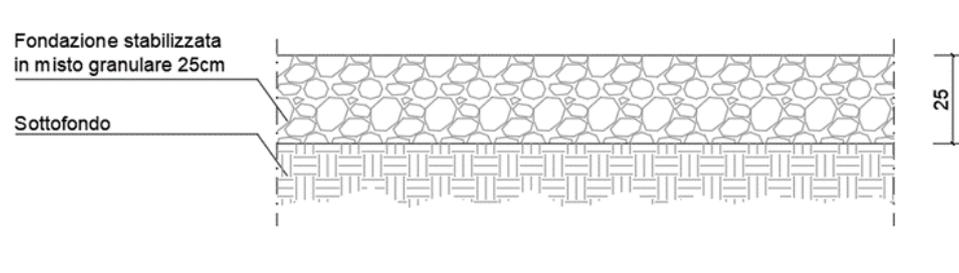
Composizione sovrastuttura per strade sterrate – TIPO P1F
